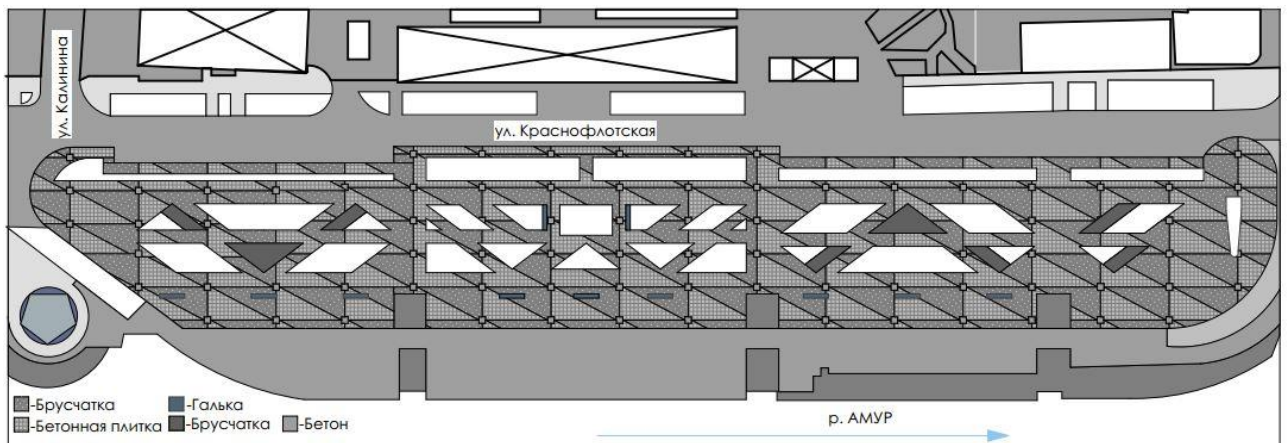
План покрытий набережной р. Амур г. Благовещенск
